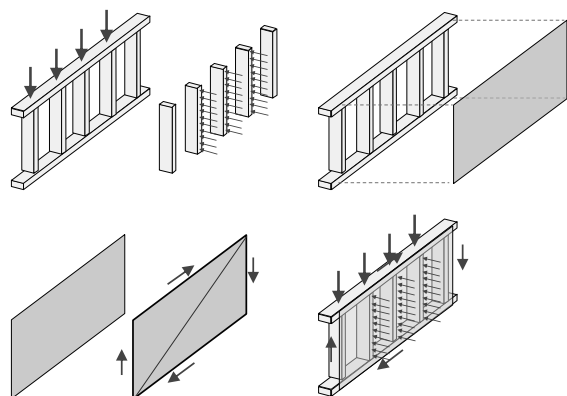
Composizione dell'elemento di parete intelaiata - funzione strutturale delle sue componenti
